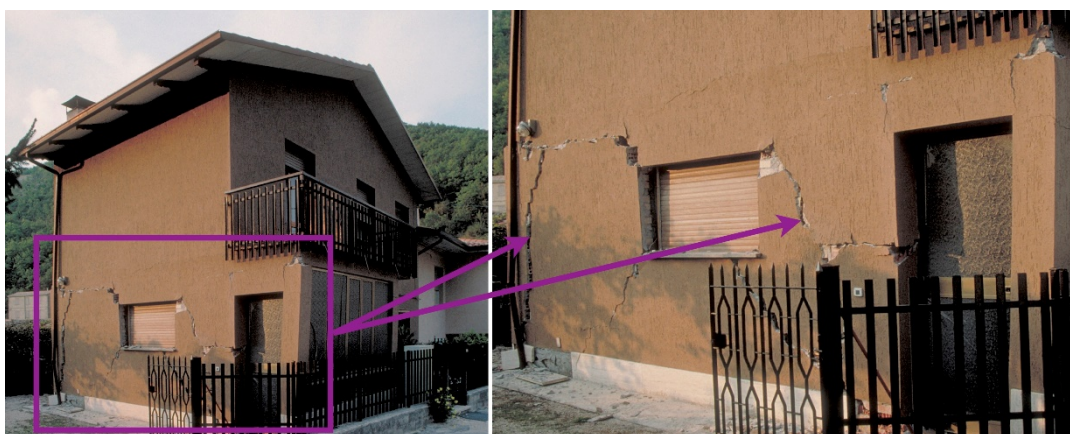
Tremblement de terre en Ombrie, Italie, en 1997. Fissures traversantes longues et étendues au rez-de-chaussée d'une maison familiale en maçonnerie : [degré de dommage 3](#)
